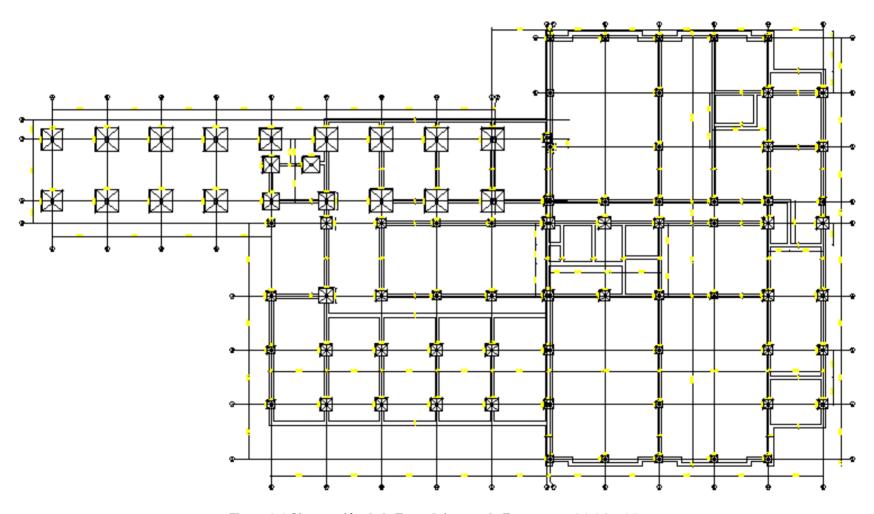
Cimentación de la Torre Oriente y de Estructuras 4.1 4.2 y 4.3
